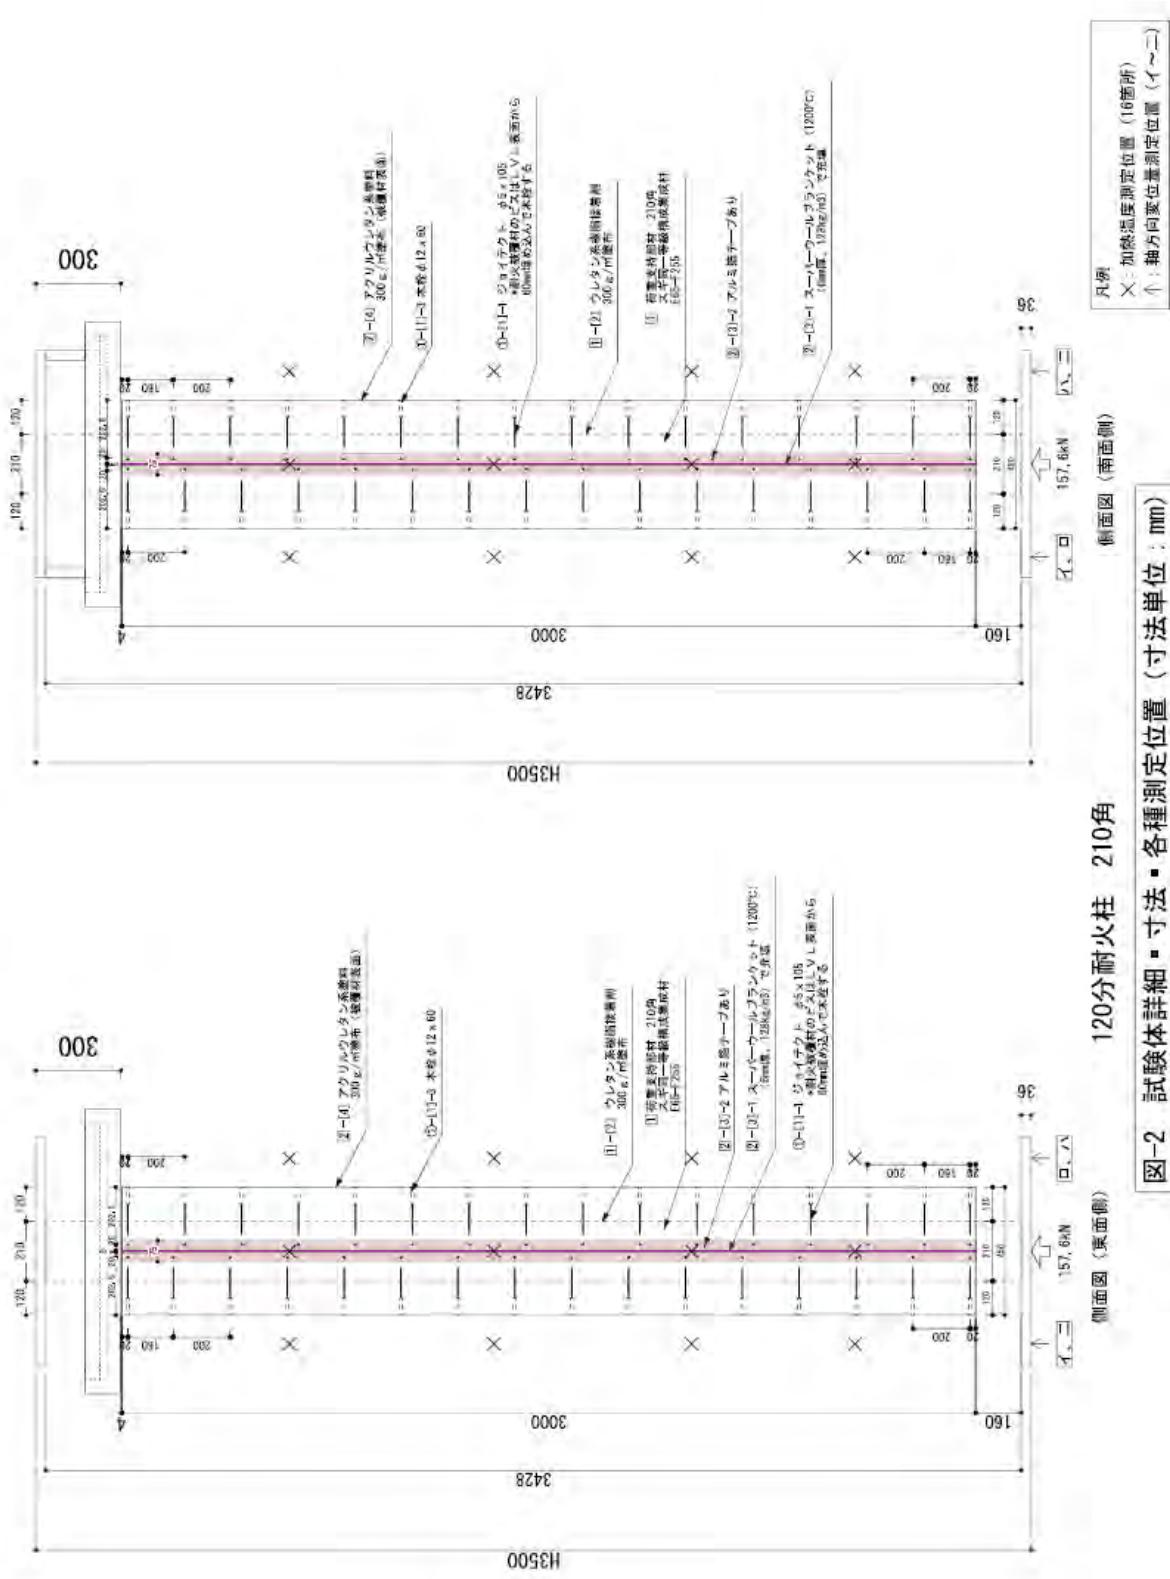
試験体詳細・寸法・各種測定位置（寸法単位：mm）
